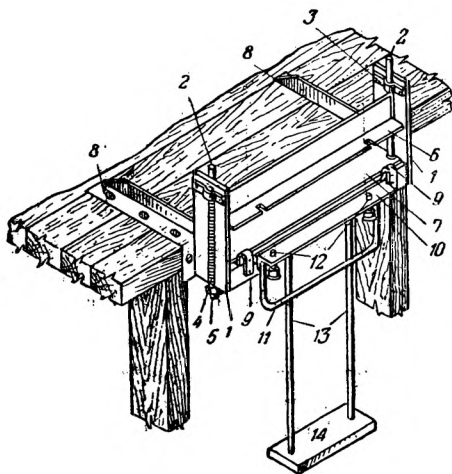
Станок № 2 конструкции А. И. Демина для заготовки лежачих фальцев:
